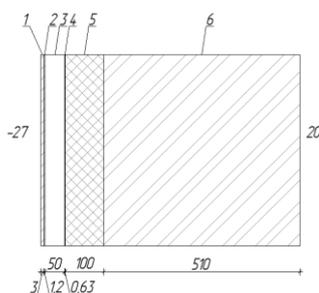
Схема конструкции наружной стены из силикатного кирпича
